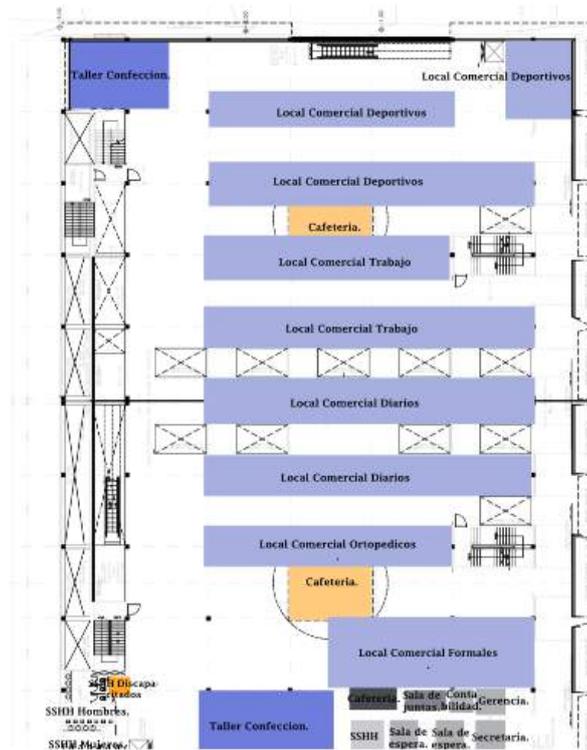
Zonificación CC Juan Cajas. Planta Baja.
